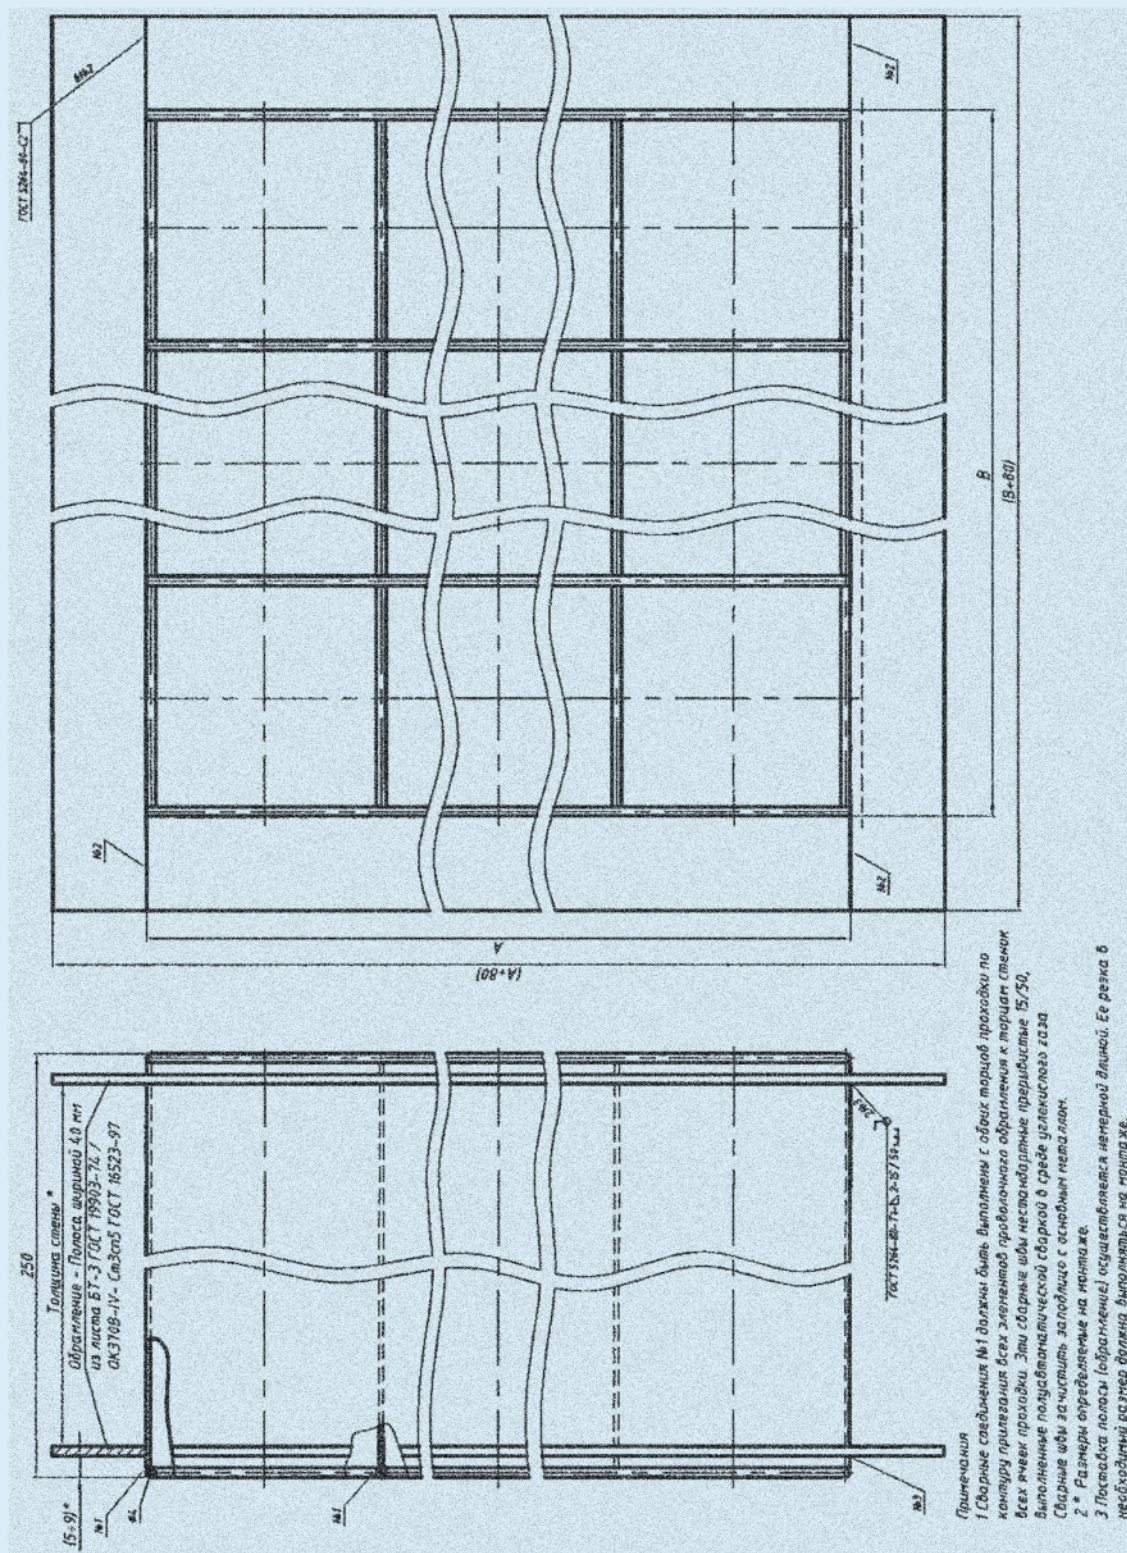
Общий вид блоков проходок коробчатых (его металлоконструкции).
